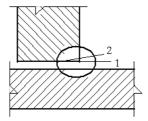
Схема расчетных сечений сварного соединения сугловым швом
